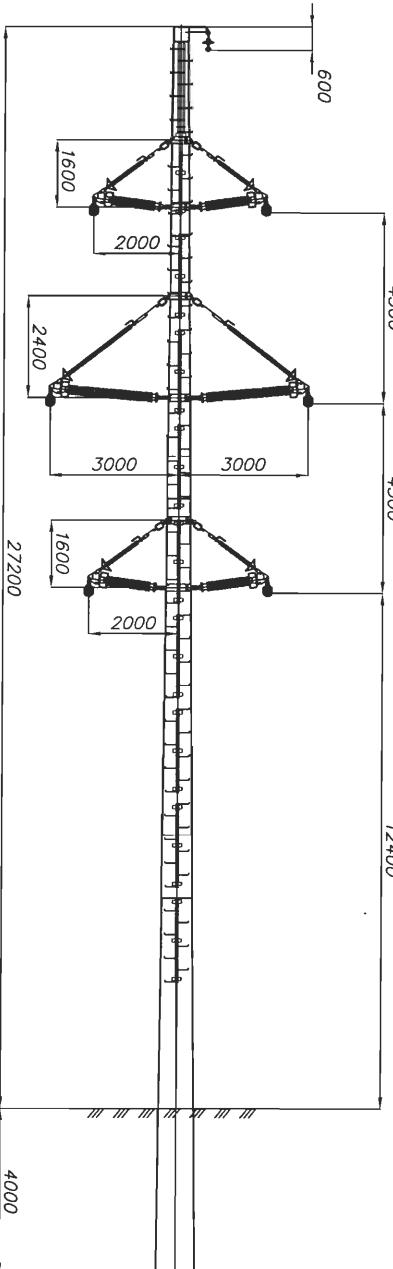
Схема установки заземлителя (чертеж № 3602тм-ВЛ-II-24).
